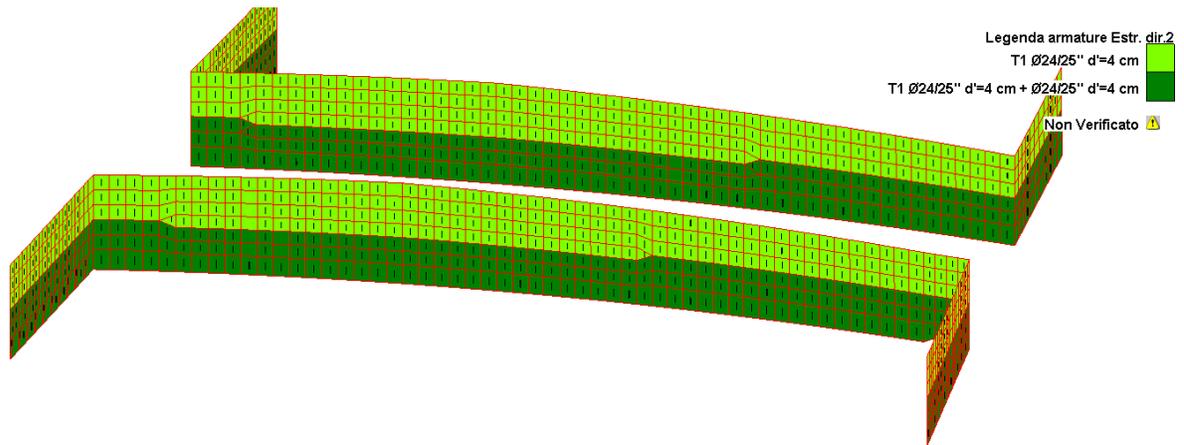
Armatura fusto Spalla di Estradosso direzione 2
